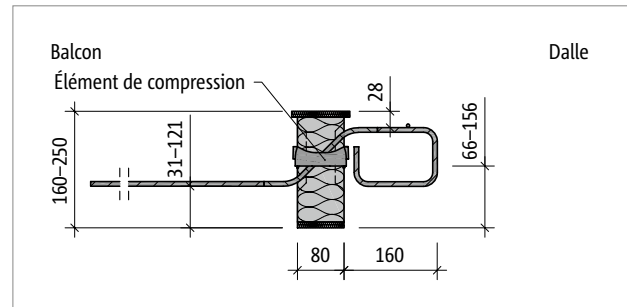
Schöck Isokorb® T type Q-E-W-V4 : coupe du produit
